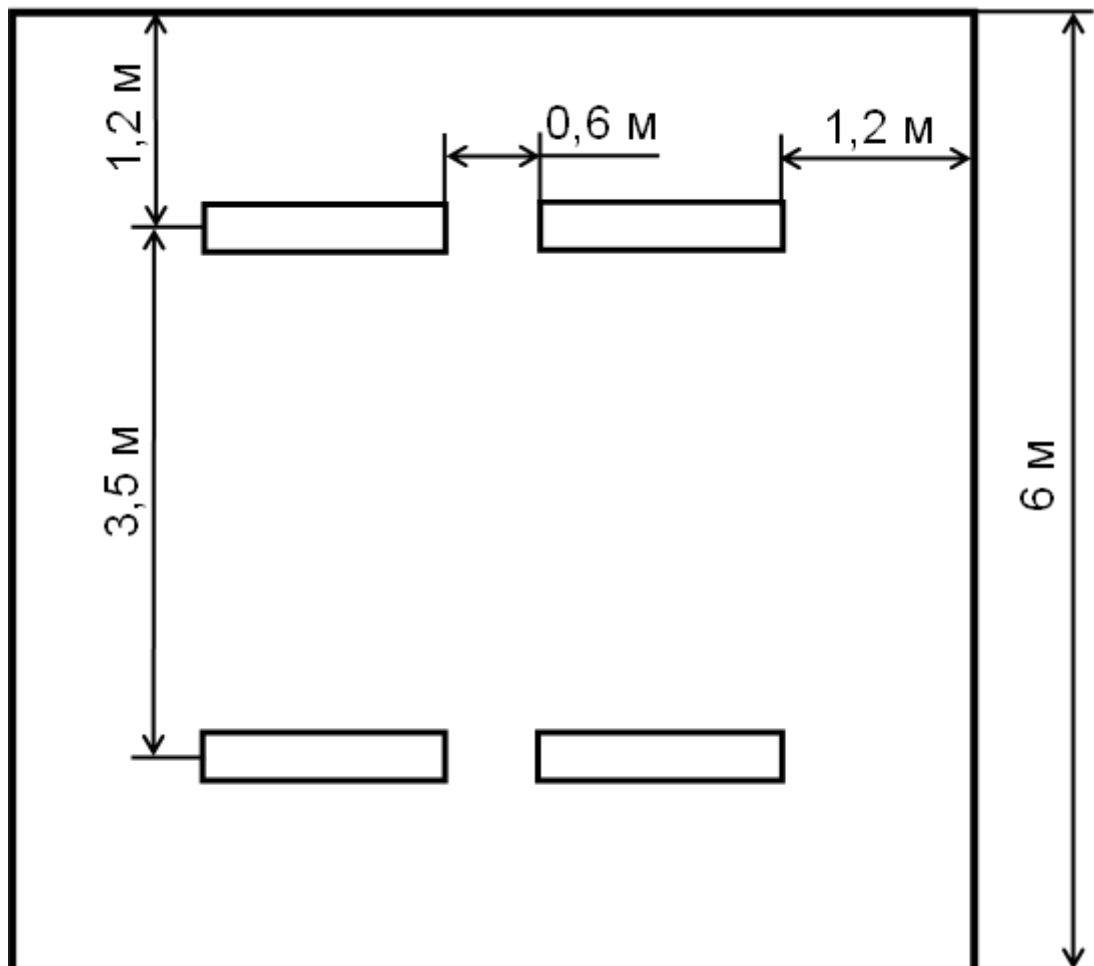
План и размещение светильников с люминесцентными лампами
